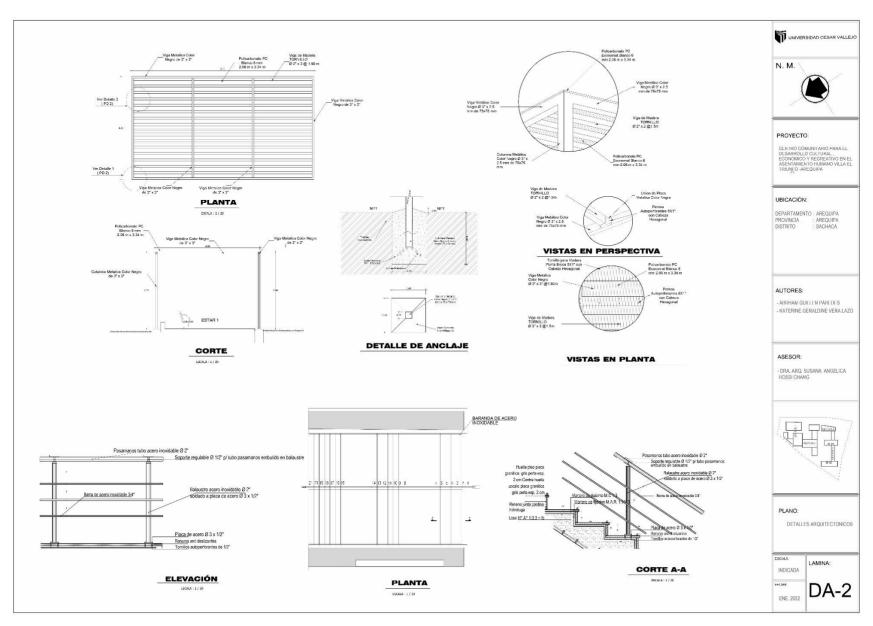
Plano de Detalles Arquitectónicos (Barandas metálicas, pérgola) - Elaboración propia
